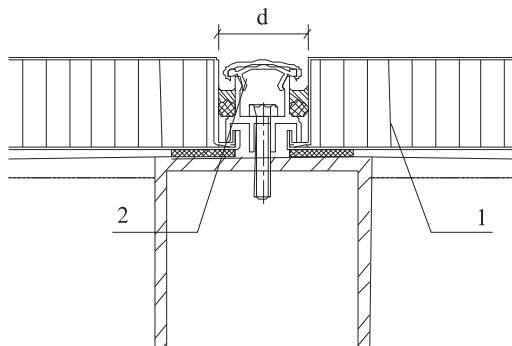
扣压式蜂窝铝板连接构造示意图
